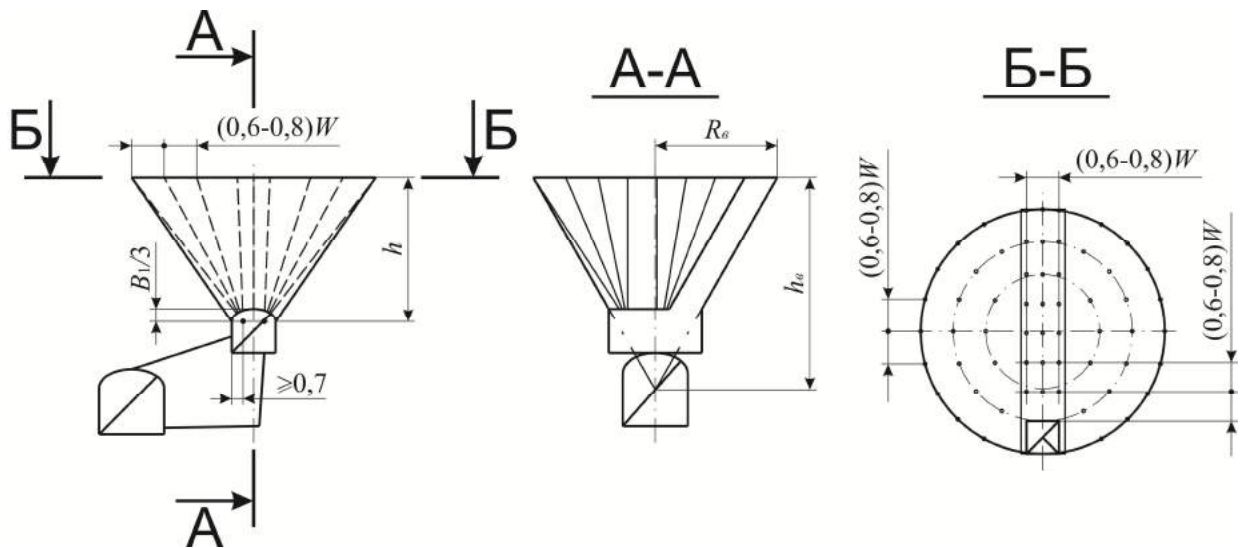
Розрахункова схема розвороту воронки свердловинами
